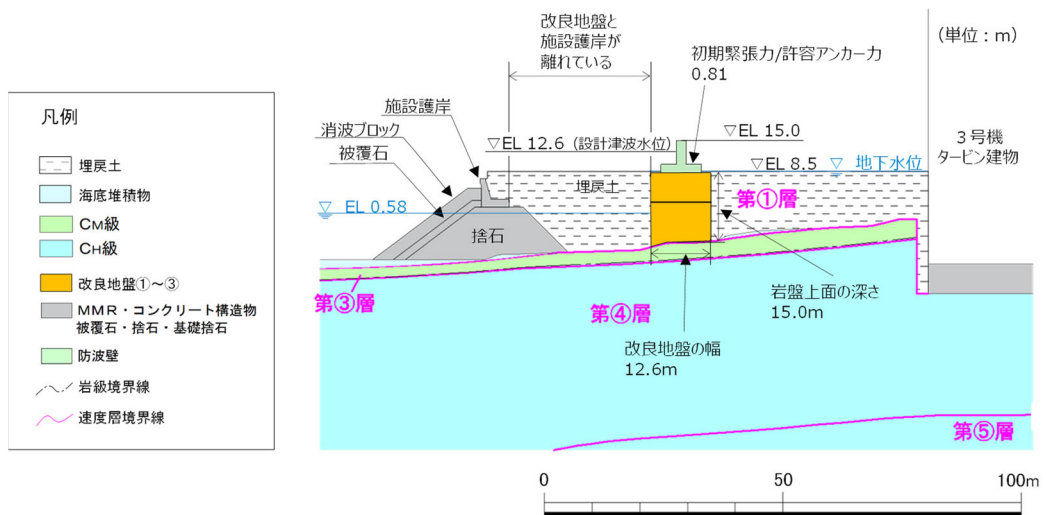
防波壁（逆 T 擁壁）の横断面図（④-④断面）
